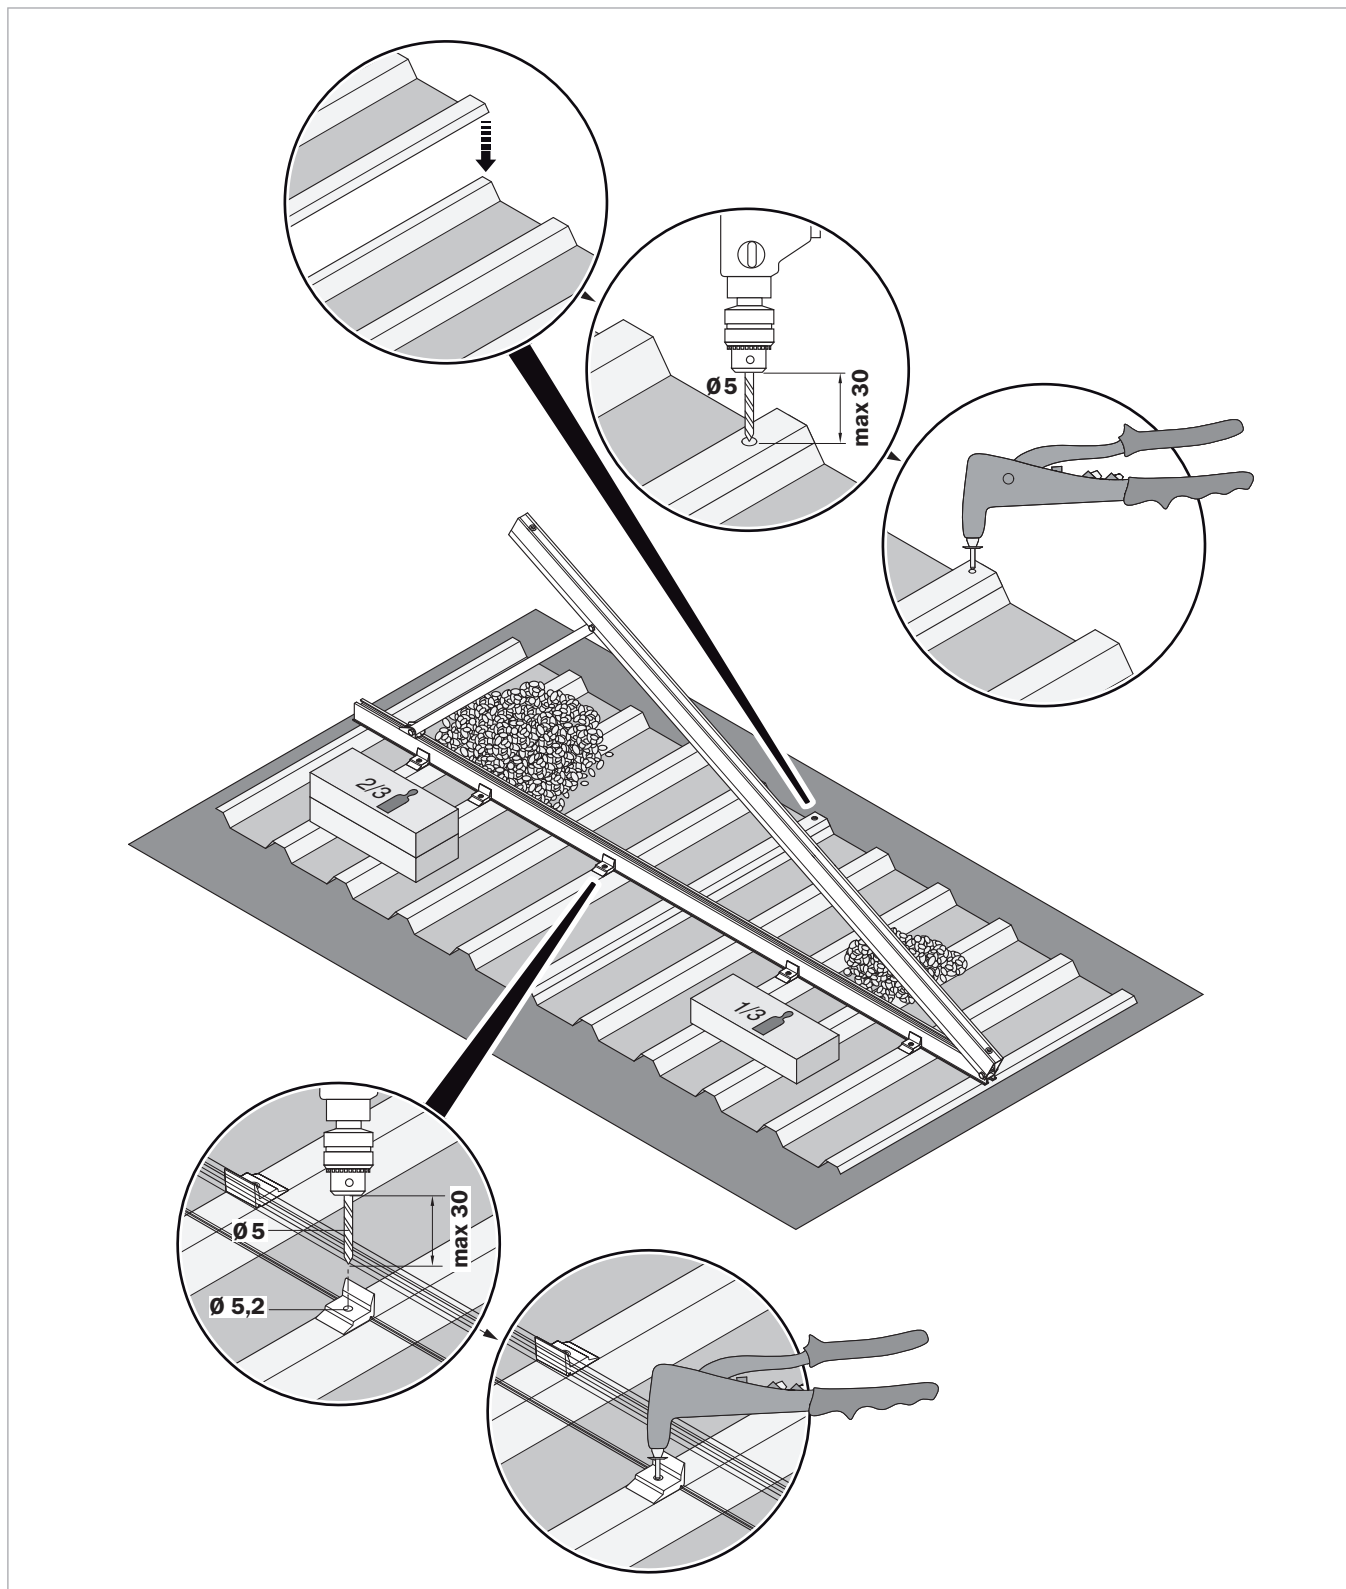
Montaggio del supporto per tetto piano su lamiera trapezoidale con apposito kit
